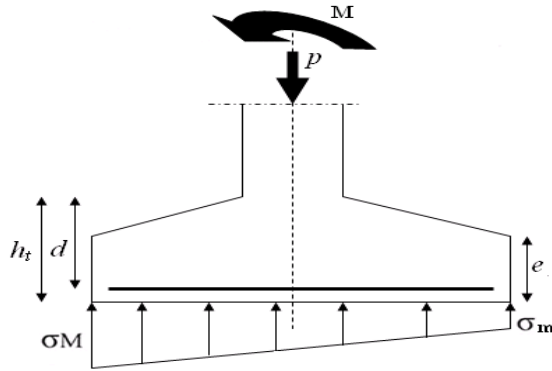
Diagramme des contraintes agissant sur les fondations.
